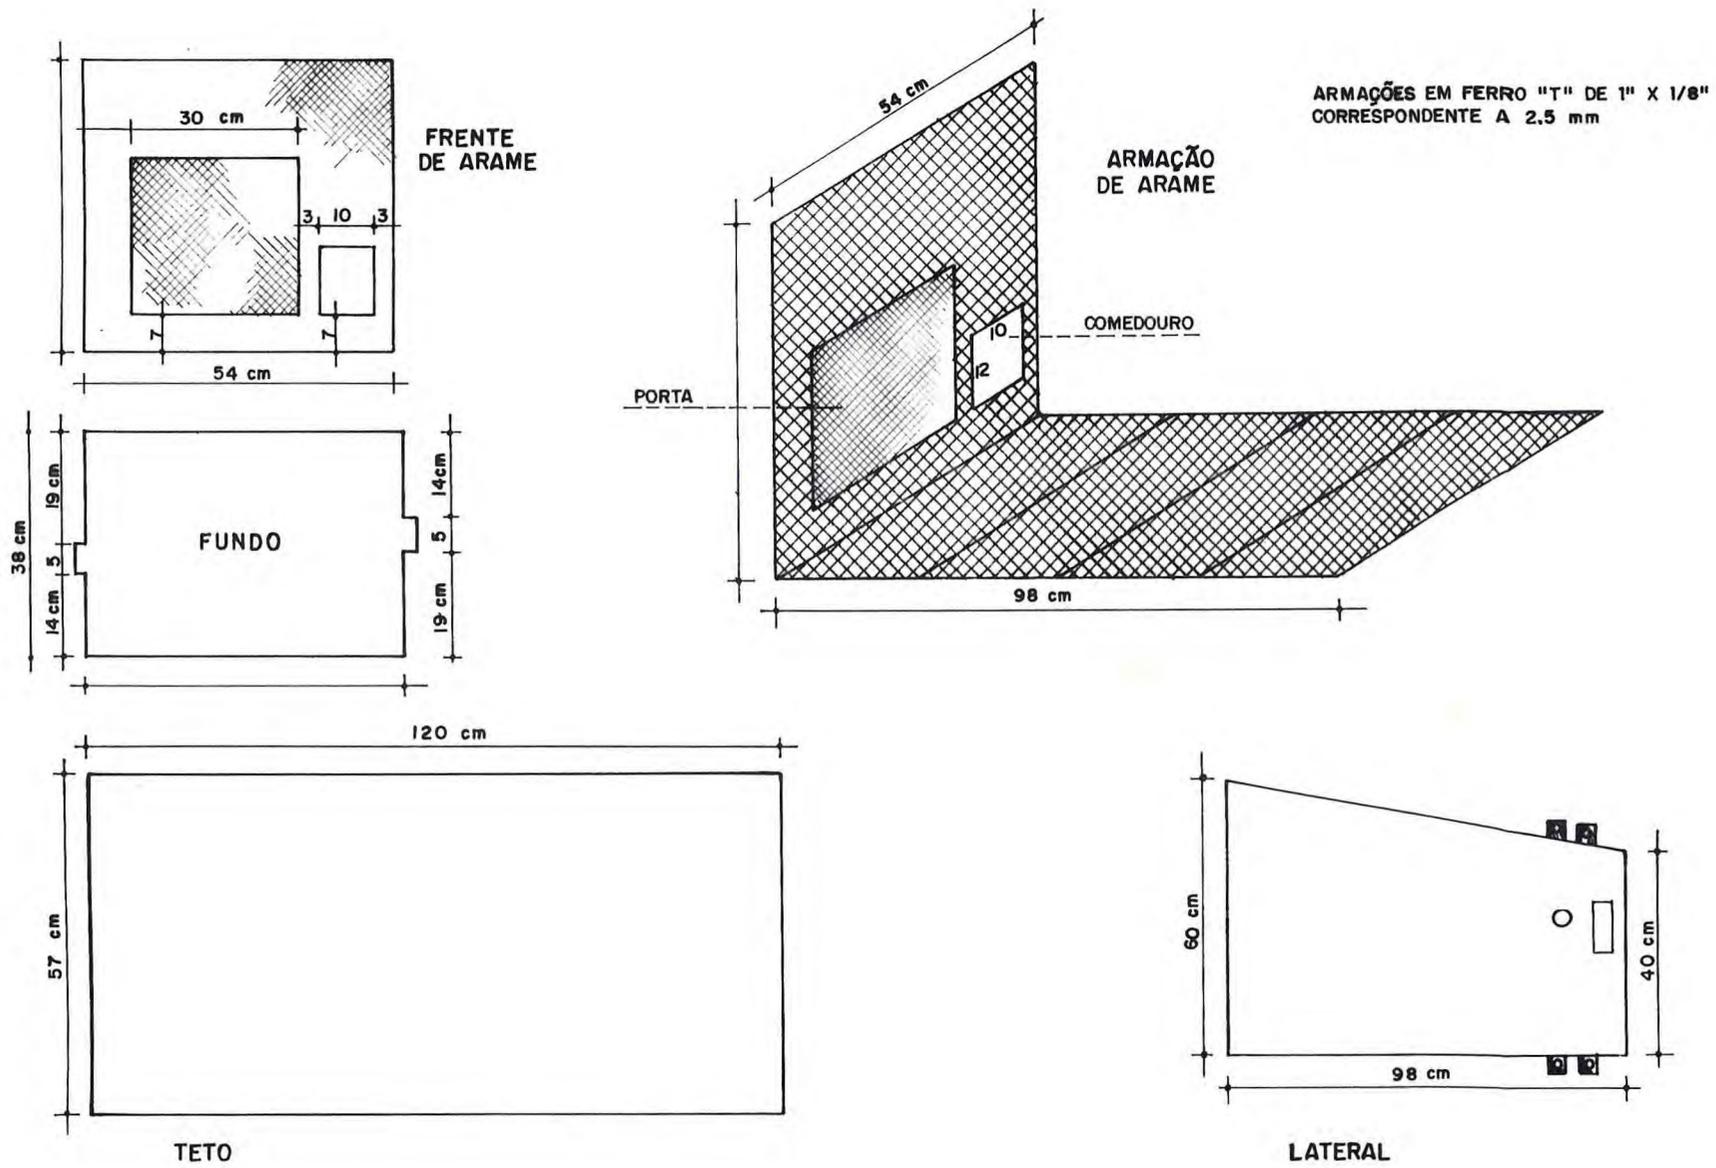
Armação da gaiola de concreto pré-moldado (I).
